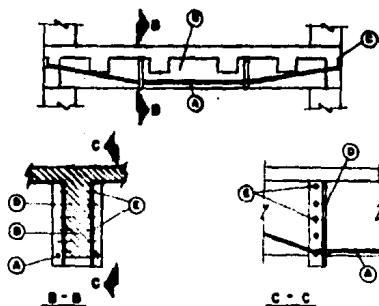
REFUERZO DE VIGA CON TENDONES POSTENSADOS
